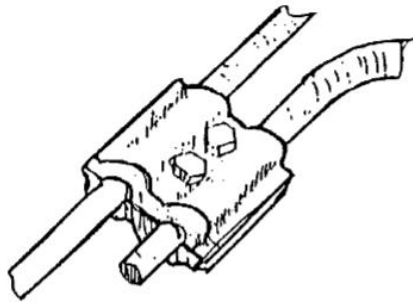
Esempio di collegamento ai ferri del pilastro o del plinto con piastra metallica (o con altri elementi metallici) incorporata nel getto del calcestruzzo, particolarmente adatti per elementi prefabbricati
